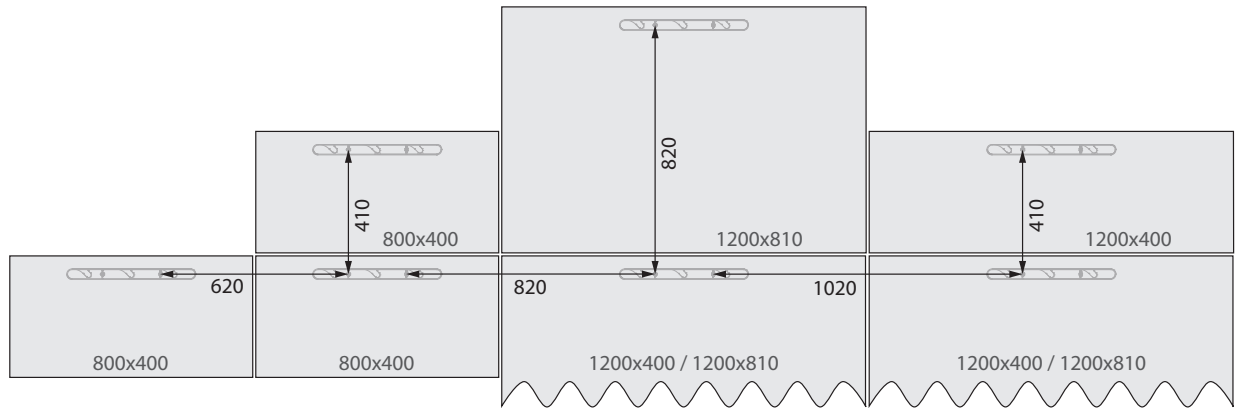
Bohrabstände für alle Formate inkl. 10 mm Fuge – alle Angaben in mm
